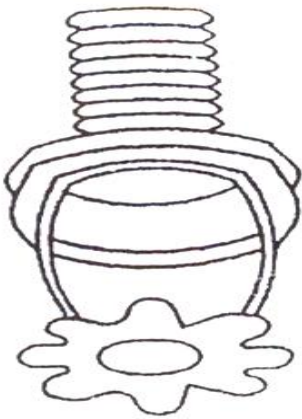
Sprinkler Head Tipe Side Wall
